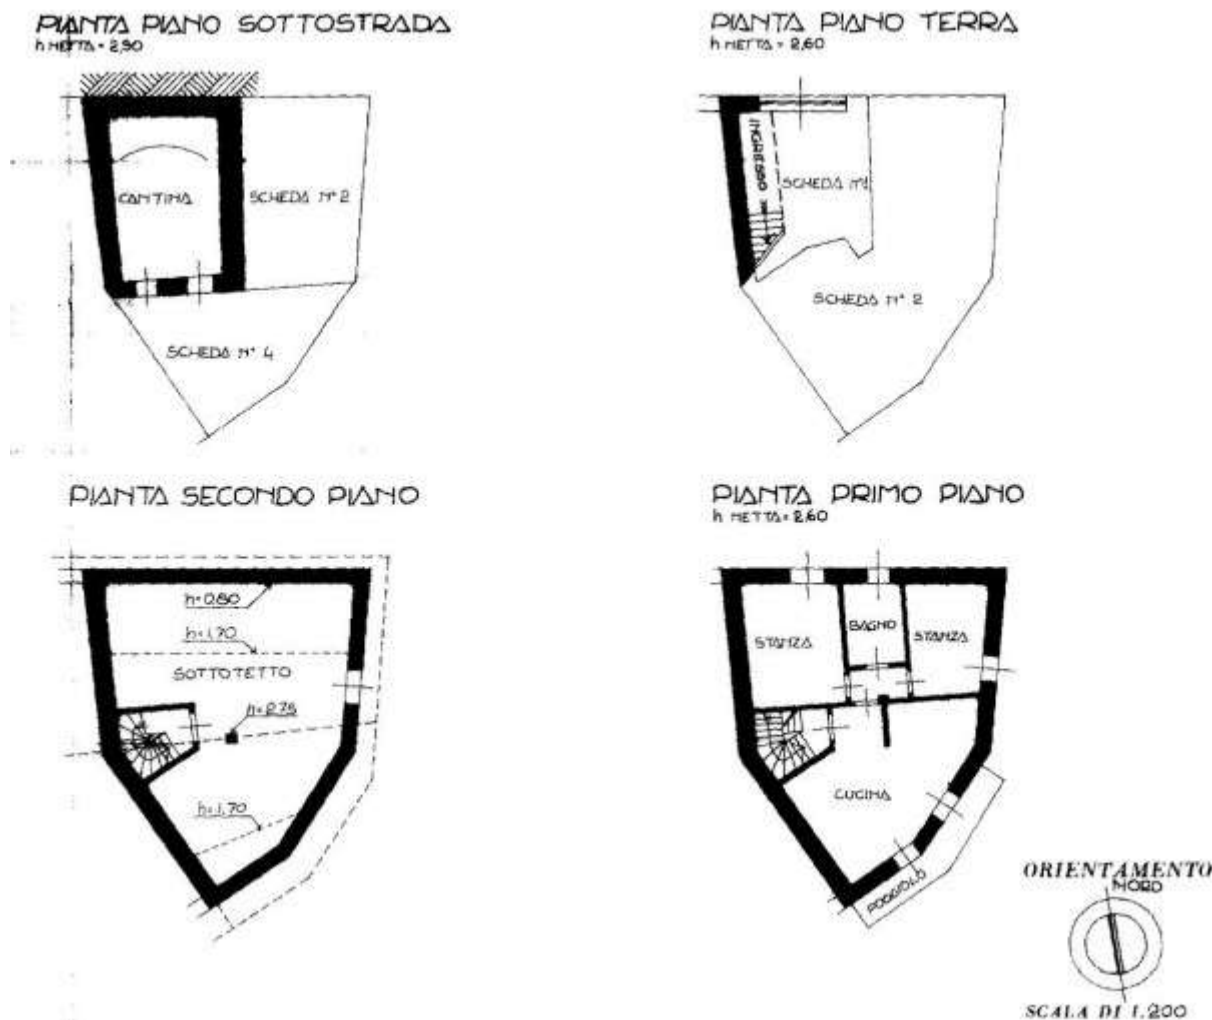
scheda n. 3 (appartamento e cantina – estratto dalla planimetri catastale).
